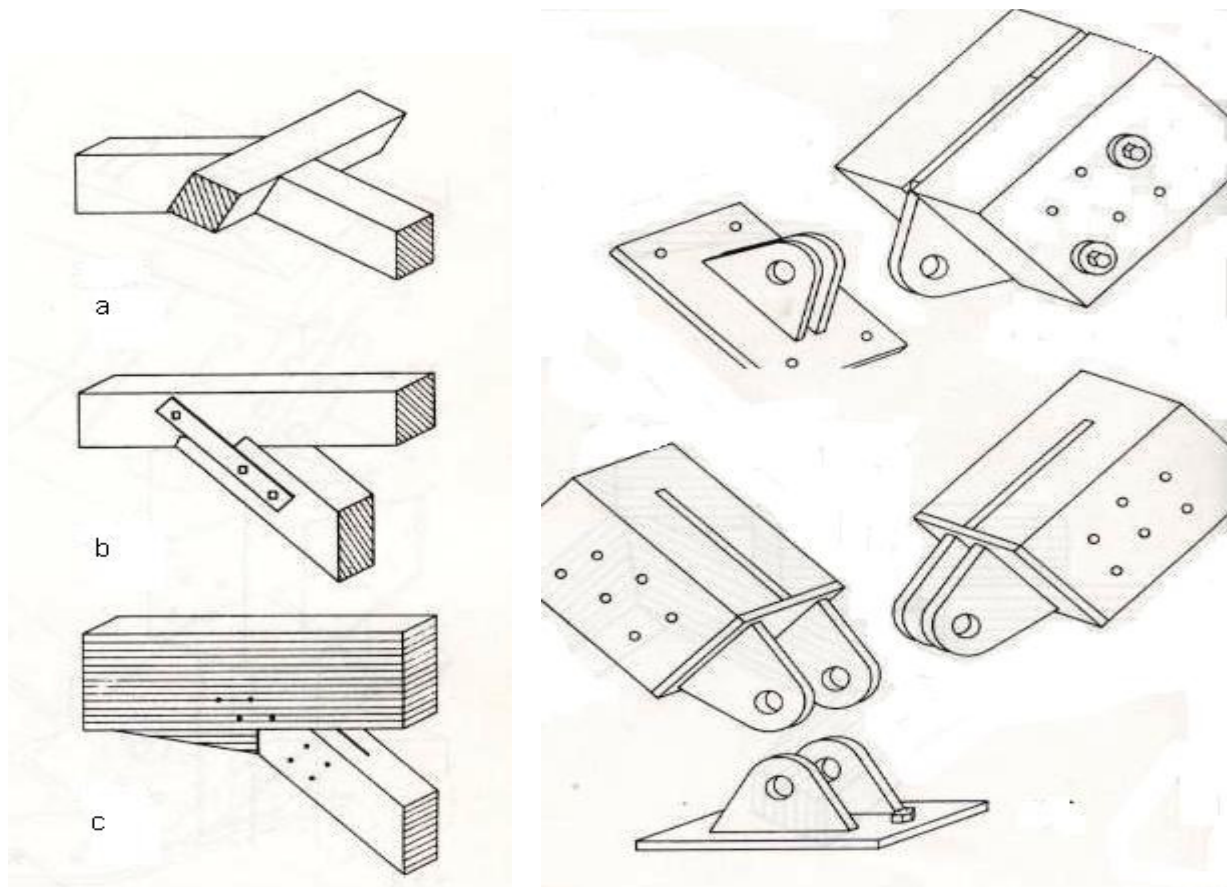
Anschlussdetails [Alois Mucha Holzbrücken S.41-42]
